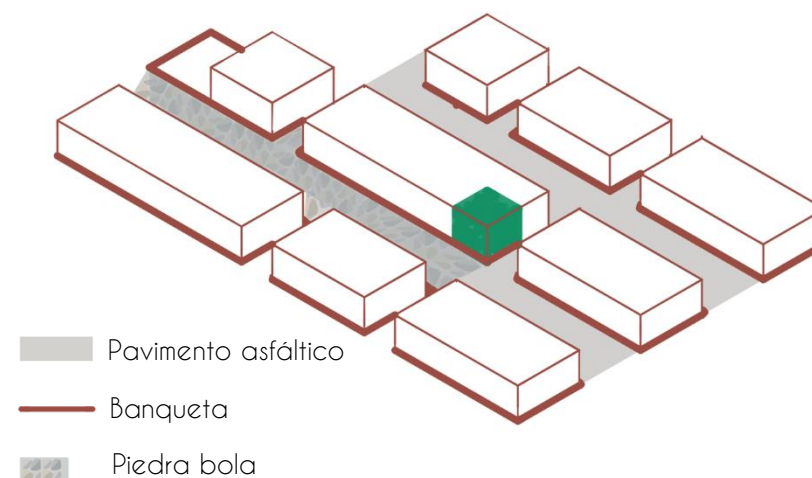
Pavimentos en calles cercanas a Casa Analco Fuente: elaboración propia
